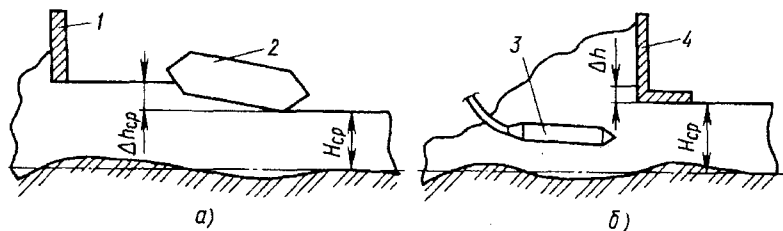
Схема уплотняющего рабочего органа с поверхностным (а) и глубинным (б) вибратором: 1 – дозирующая заслонка; 2 – вибробрус; 3 – глубинный вибратор; 4 – профилирующая заслонка.
